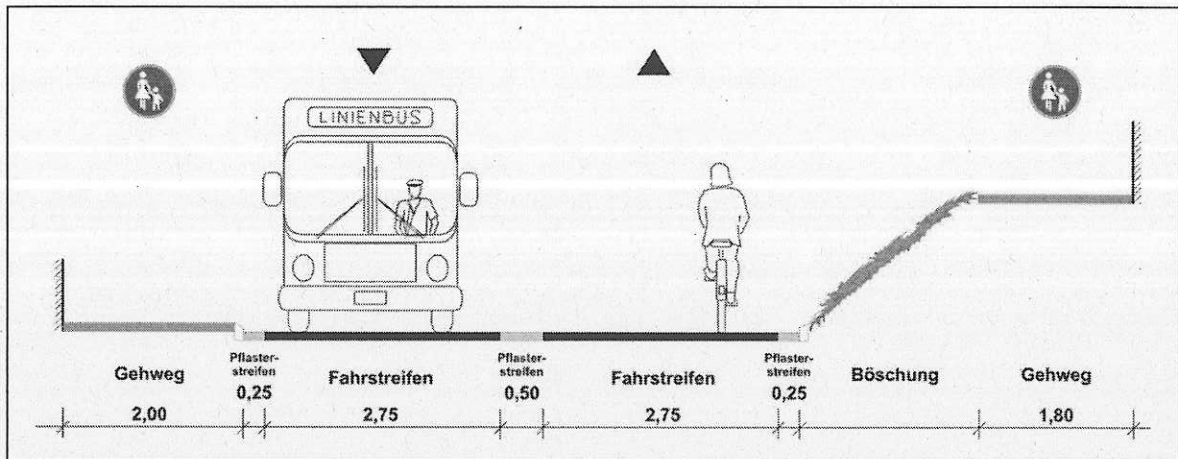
Abschnitt II – Straßenraumquerschnitt Variante III-1
